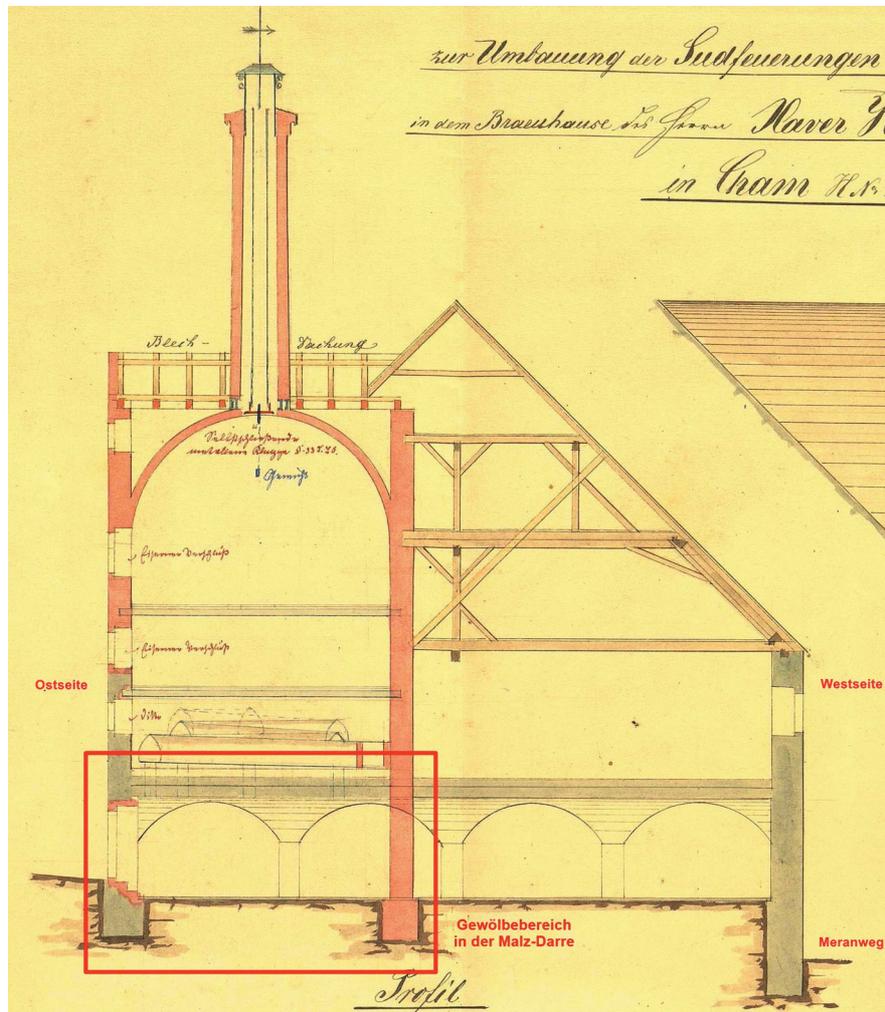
Querschnitt der eingebauten Malz-Darre aus dem StAam/Bezirksamt Landratsamt Cham, Baugenehmigungsakte 150/1890 (Einbauten sind rot eingefärbt)
